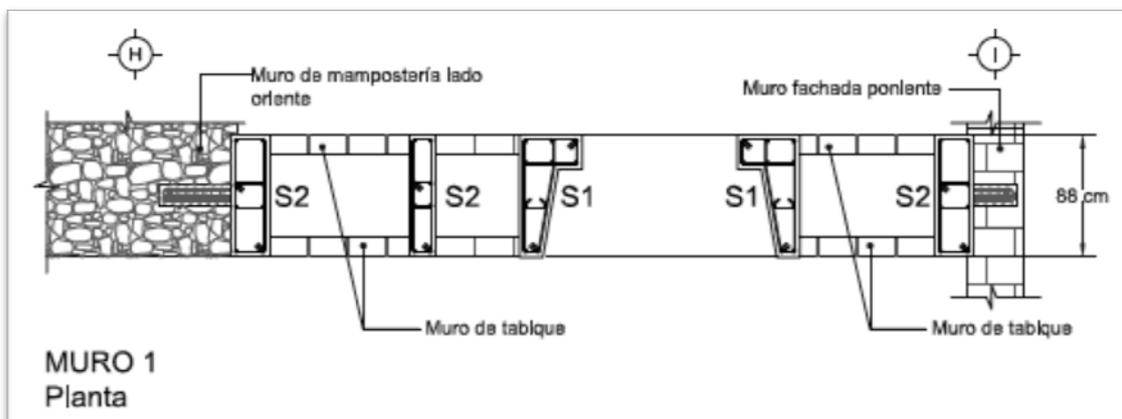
Detalle constructivo del muro doble de ladrillo rojo en planta. Detalle elaborado por Instituto de Ingeniería.
